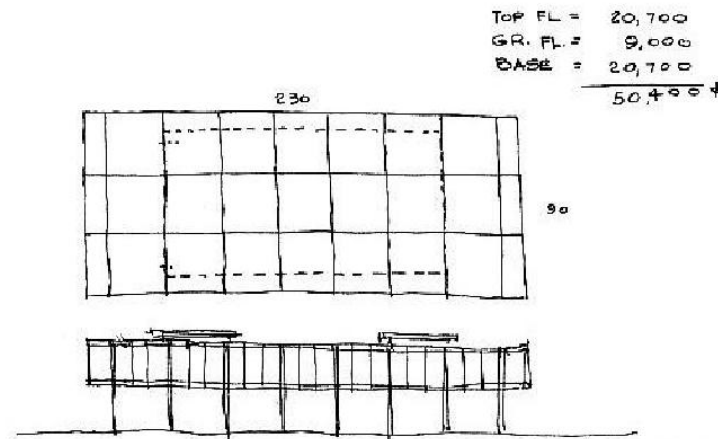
Croqui nº5, escolhido para elaboração do projeto executivo do Consulado Americano em São Paulo. Fonte: www.vitruvius.com.br
